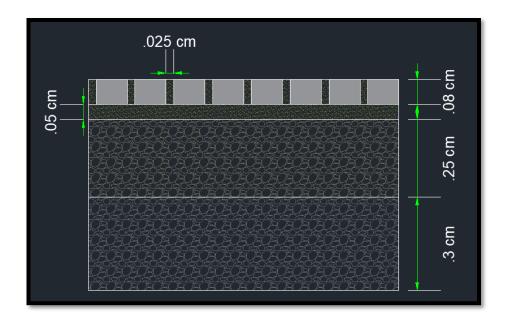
Paquete estructural del pavimento adoquinado (Elaboración propia)
